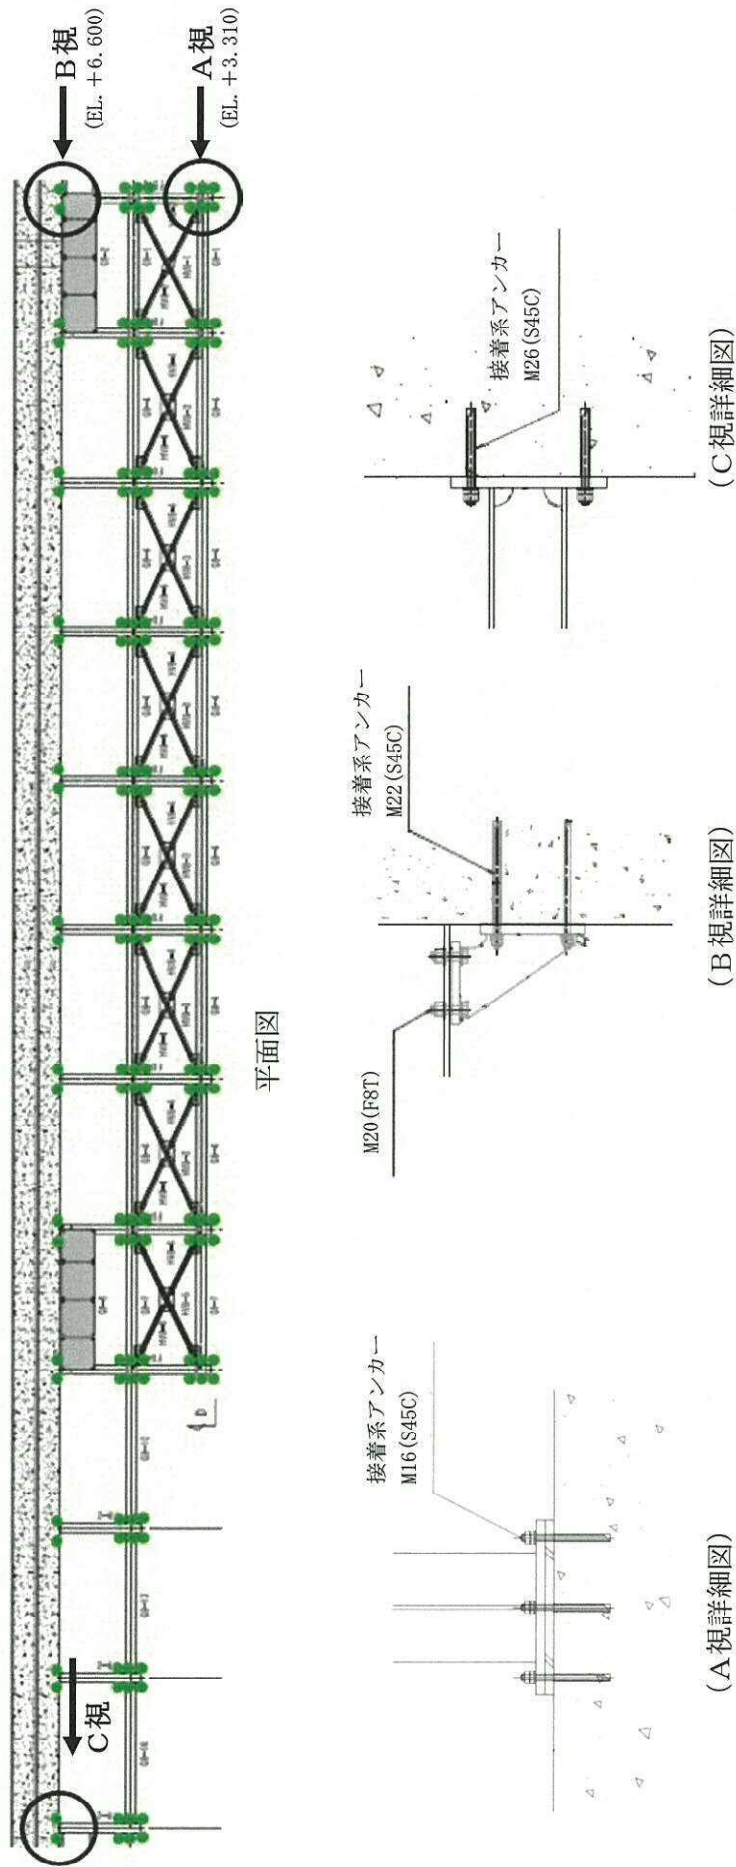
アンカーボルト配置図 (2/2) (エリア⑧)
